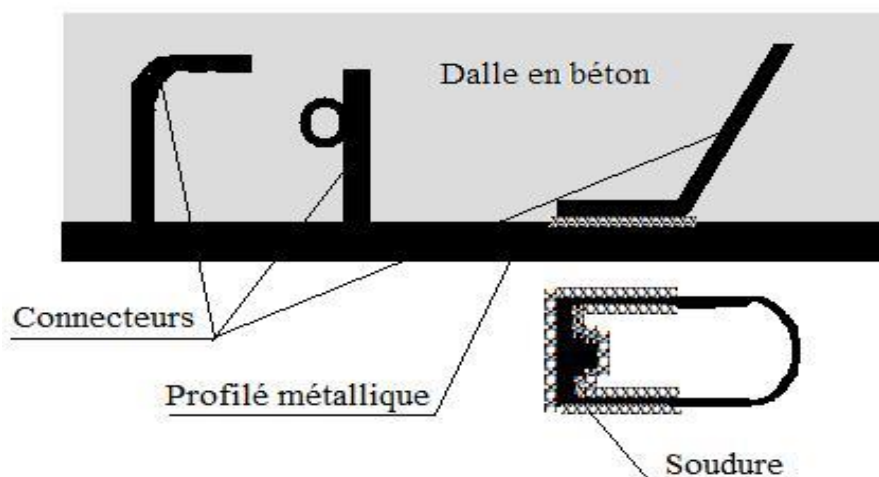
Connecteurs en forme de crochet soudés sur la semelle supérieure de la poutre métallique.
